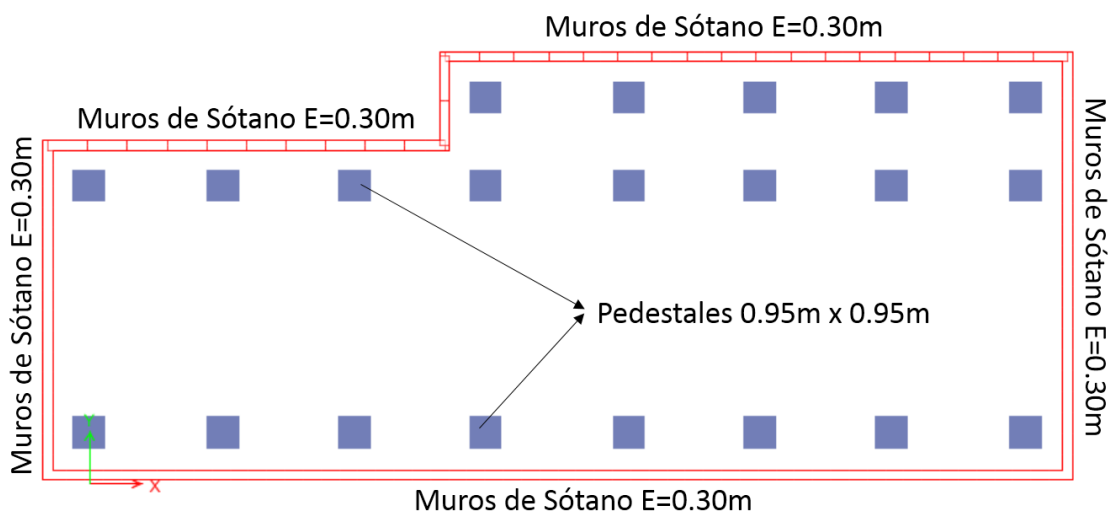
Pedestales y muros de sótano en el modelo con base aislada del “POOL DE AULAS – POOL A”, preparado para el análisis de la cimentación.
